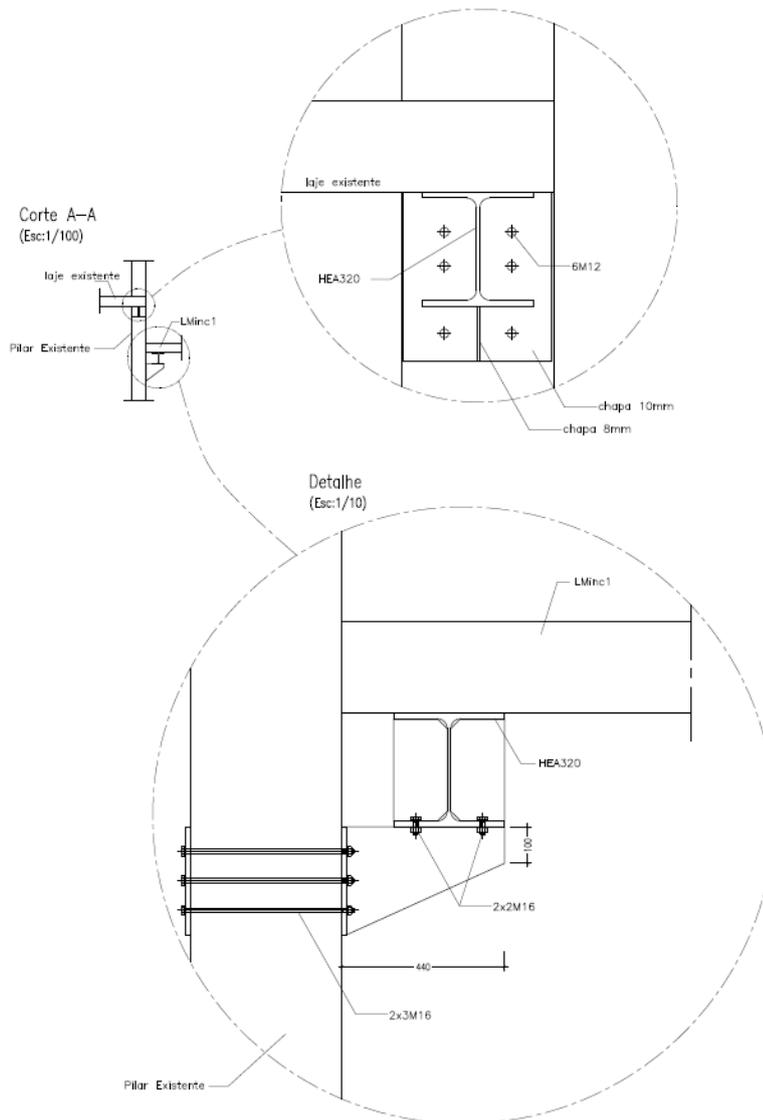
Solução de reforço estrutural das lajes e dos pilares
